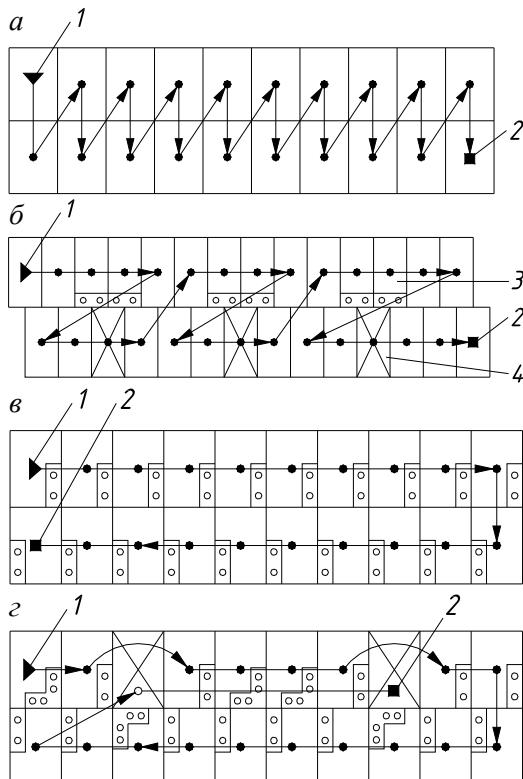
Схемы последовательности монтажа зданий из объемных блоков:
